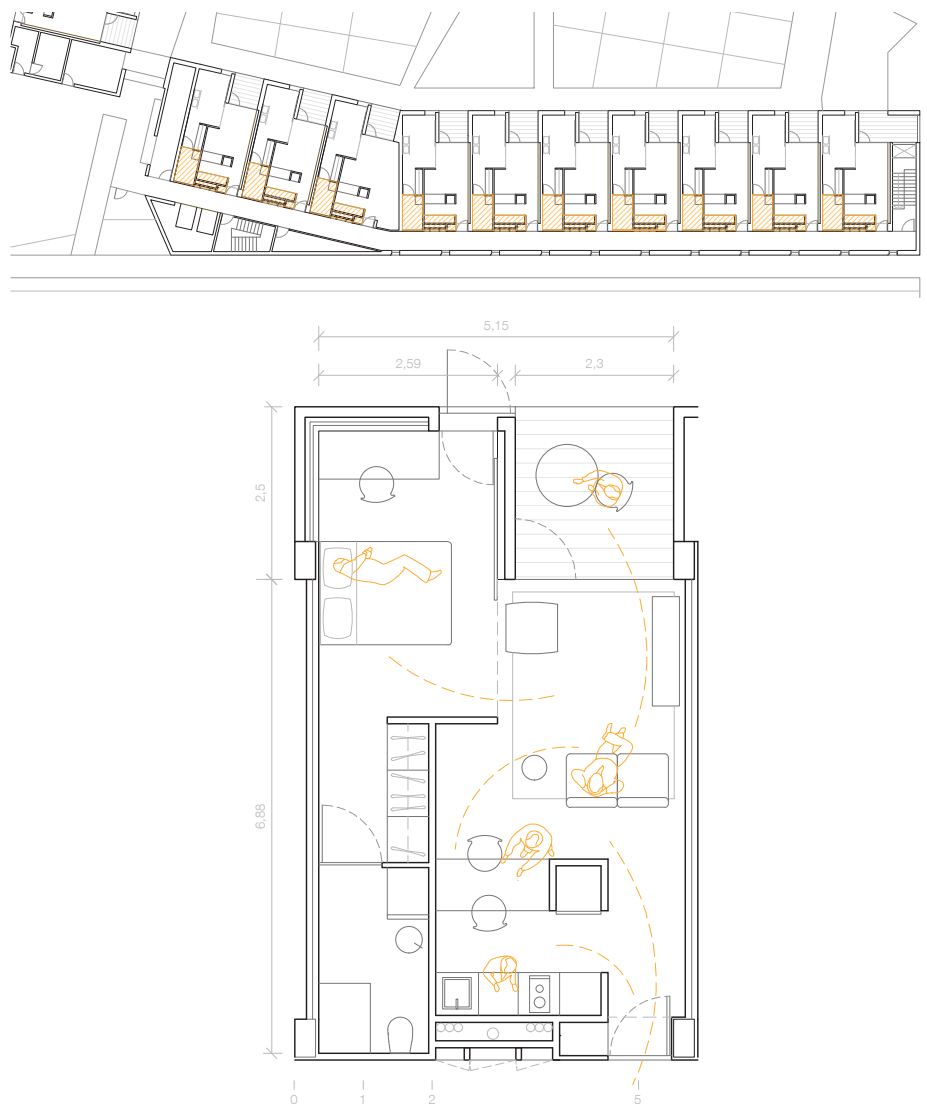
Planta general del edificio de las viviendas para mayores en Can Travi, Barcelona (2009) GRND22
